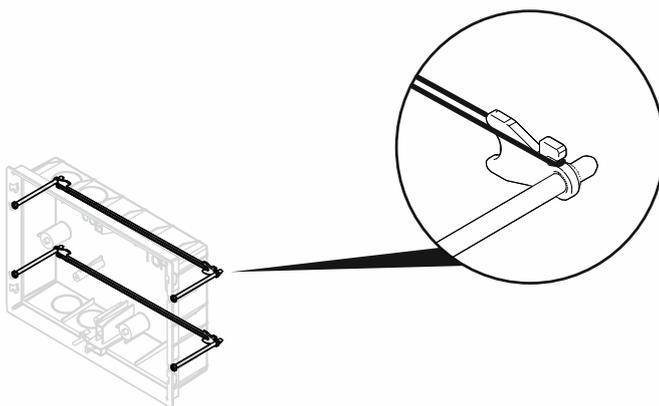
Montageset für Hohlwanddose: Gummibänder
